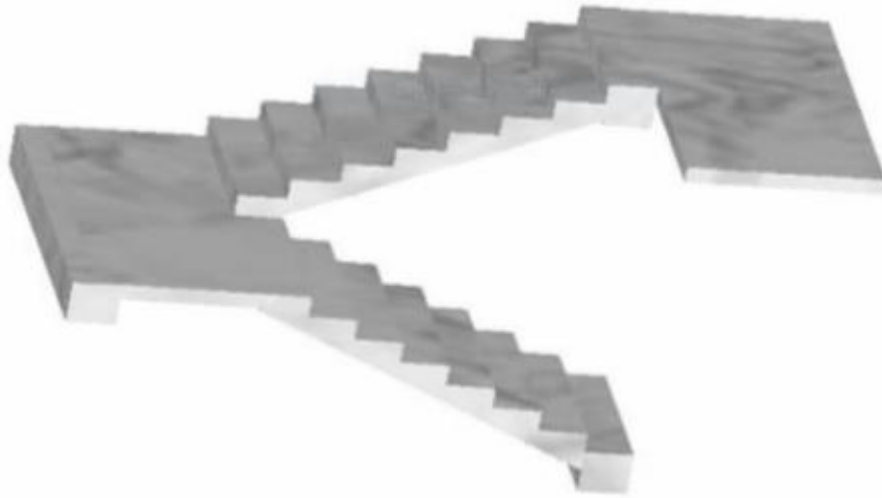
Vue en 3D de l'escalier à paillasse adjacente.
